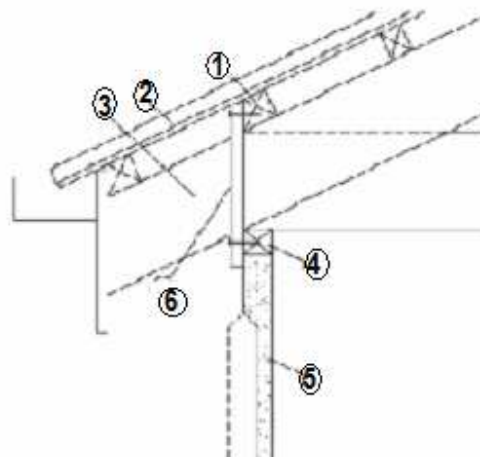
Techo en paneles ligeros. Detalles.1-Vigas secundarias de madera, 2-Cubrición,3-Vigas principales de madera, 4-Viga de conexión superior, de madera, 5-Panel prefabricado de hormigón, 6-Placa de cierre de fibrocemento.
